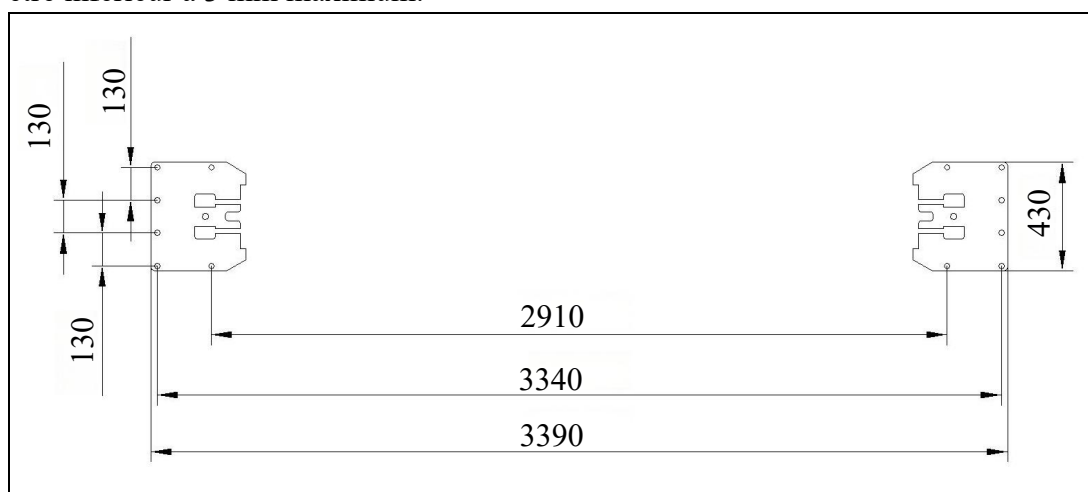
Plan de disposition des platines de colonnes (unité : mm)
